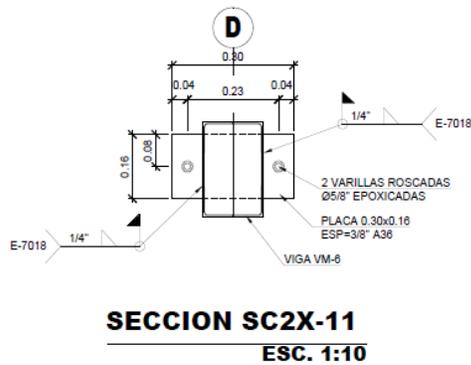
SECCIÓN DE DETALLE DE PLACA Y SOLDADURA EN CONEXIONES METÁLICAS
